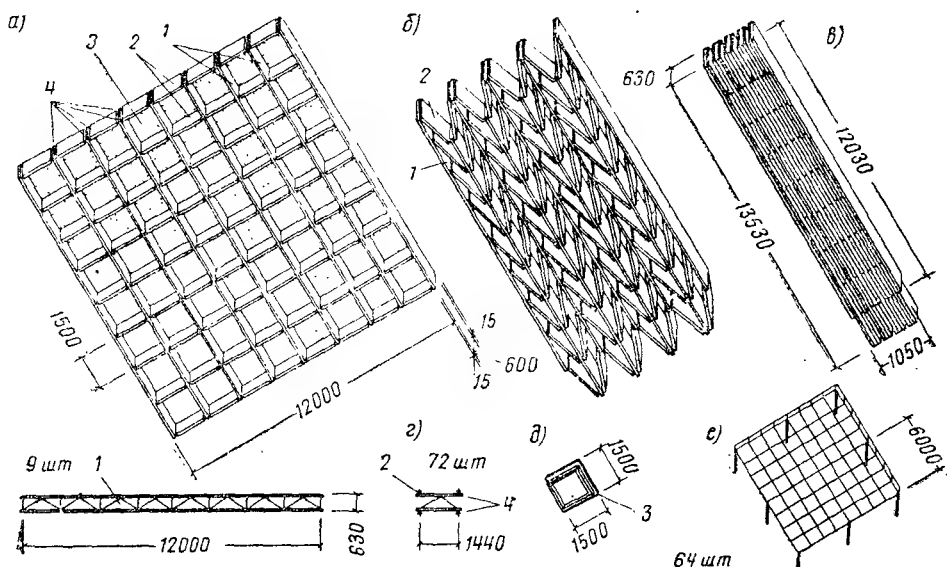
Перекрестно-ребристые покрытия из железобетона и древесины
